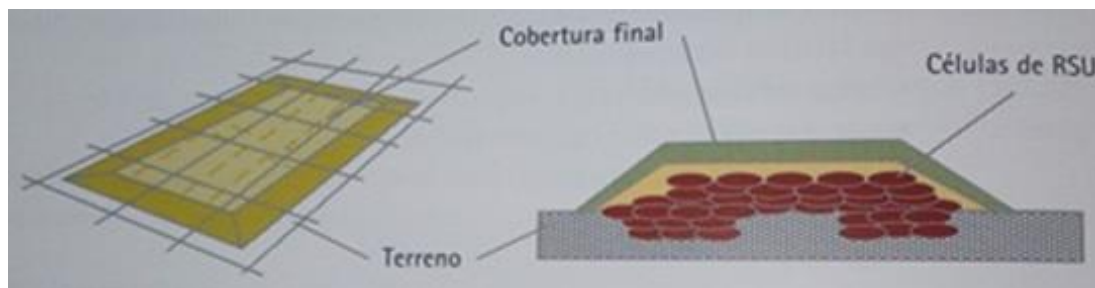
Esquema em planta e em corte de um aterro confinado em trincheira (adaptado de Cabeças & Levy, 2006).
